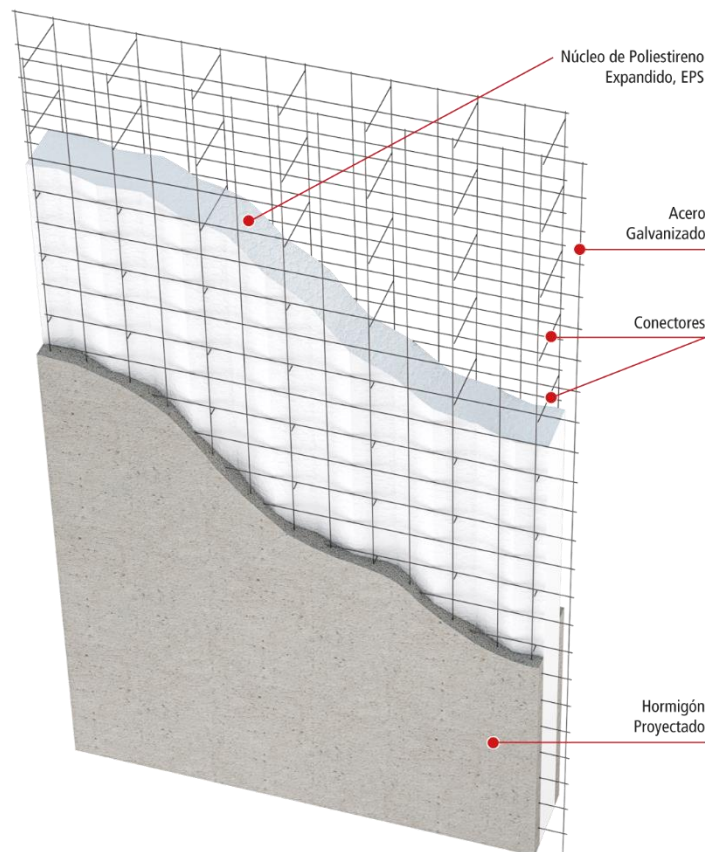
Panel – Fabricado con la incorporación de una malla tridimensional de mallazos de acero, un núcleo de poliestireno expandido (EPS) y dos capas exteriores de hormigón proyectado
